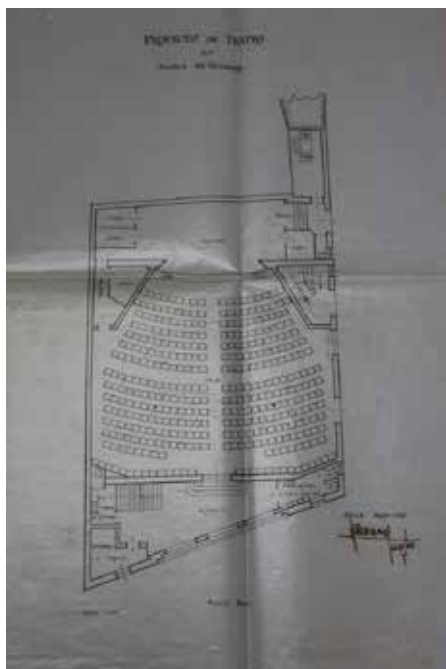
Teatro. Alcalá de Guadaira. Plano de la planta baja. J. Talavera Heredia. 1931 (AMAG).
